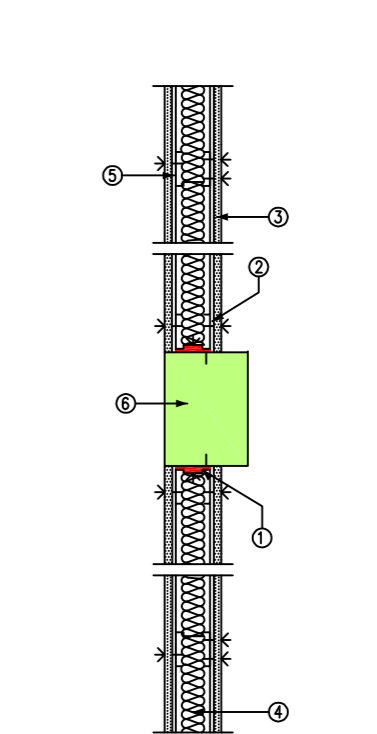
Dünne Zwischenwände aus Einfachständerwänden (als Variante von 6.1)
